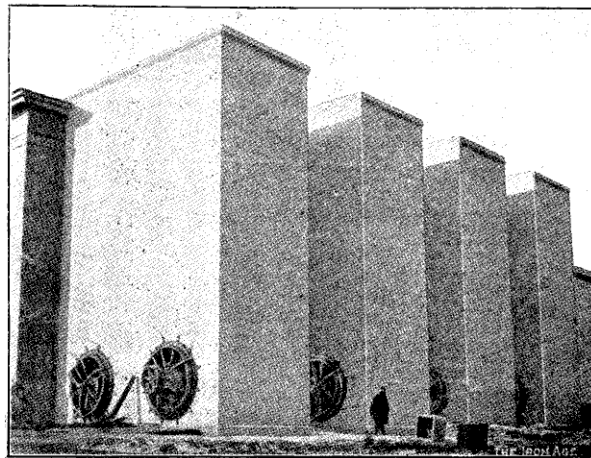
Tours de refroidissement pour les machines WESTINGHOUSE.
